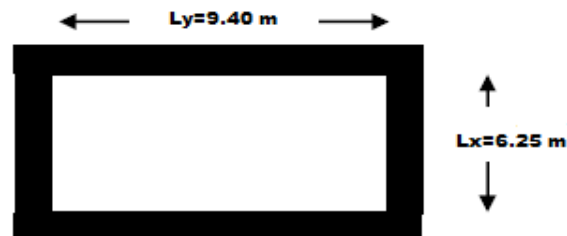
Dalle sur 04 appuis (La dalle pleine sur laquelle la coupole est ancrée)
